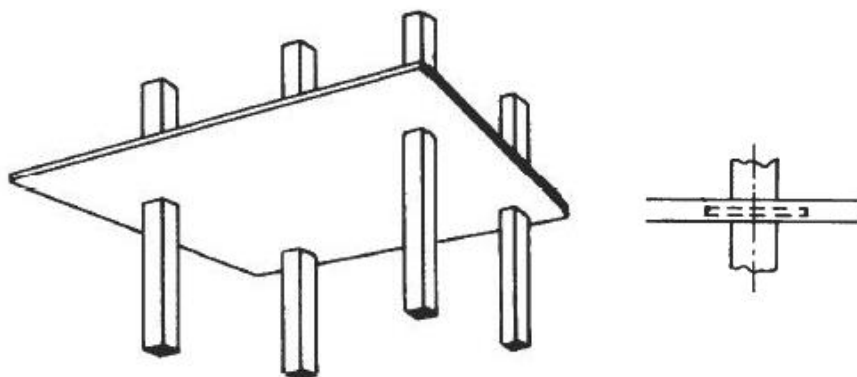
Lajes fungiformes maciças de espessura constante [B9]
